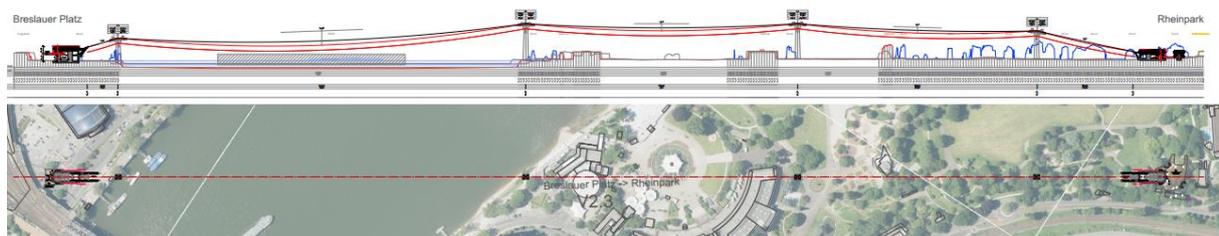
Längenschnitt, Lageplan Variante V2.3
